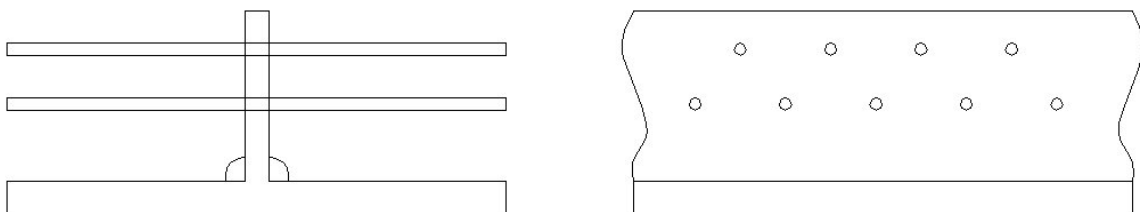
4 – Asigurarea conlucrării între structura de oțel și cea de beton prin armătură
